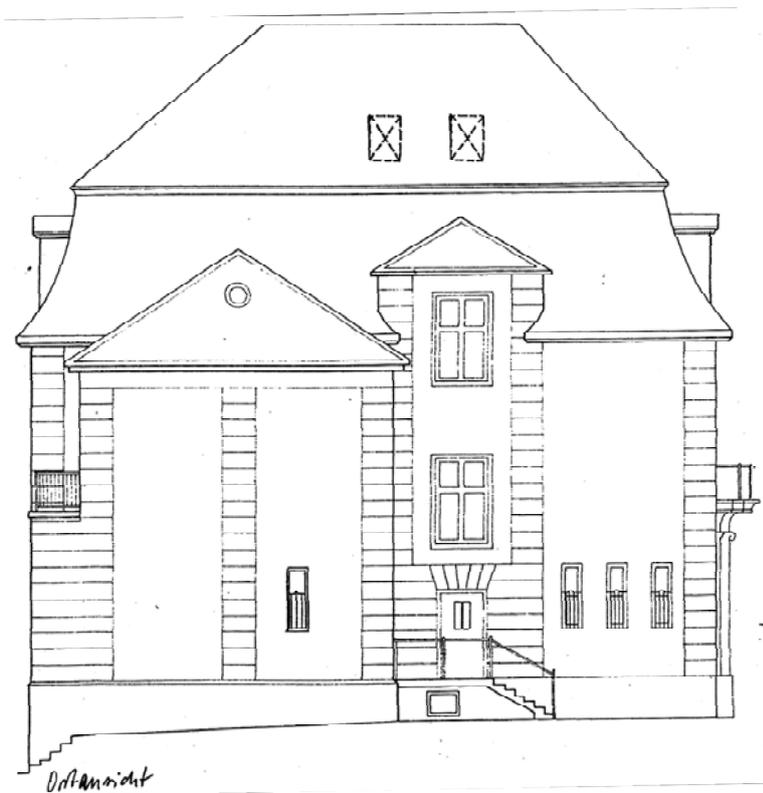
Haus Ernst, Aufriss der östlichen Fassade, o. J.
